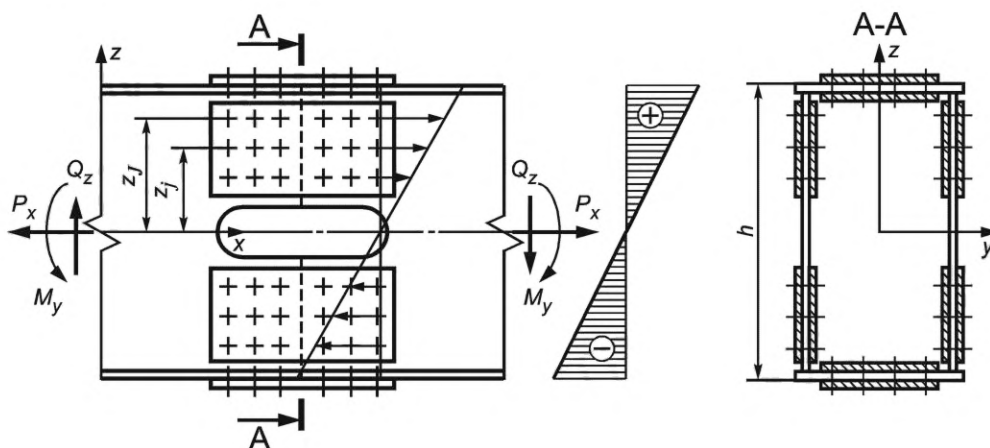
Схемы к расчету болтового соединения на накладках
